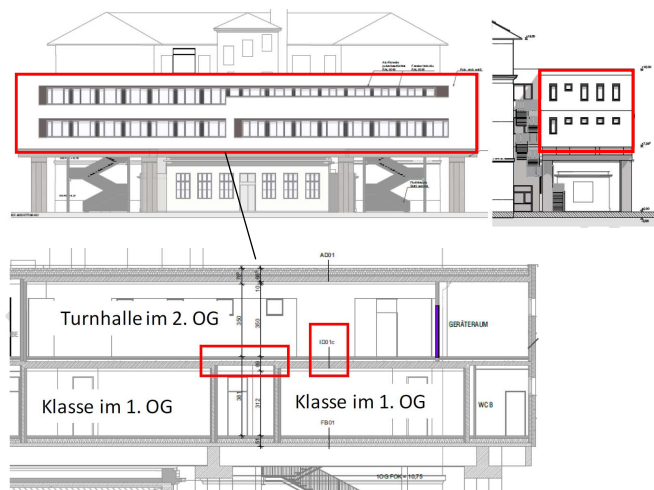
Gebäudepläne mit Ausschnitt der betrachteten Brettsper Holzdecke.
